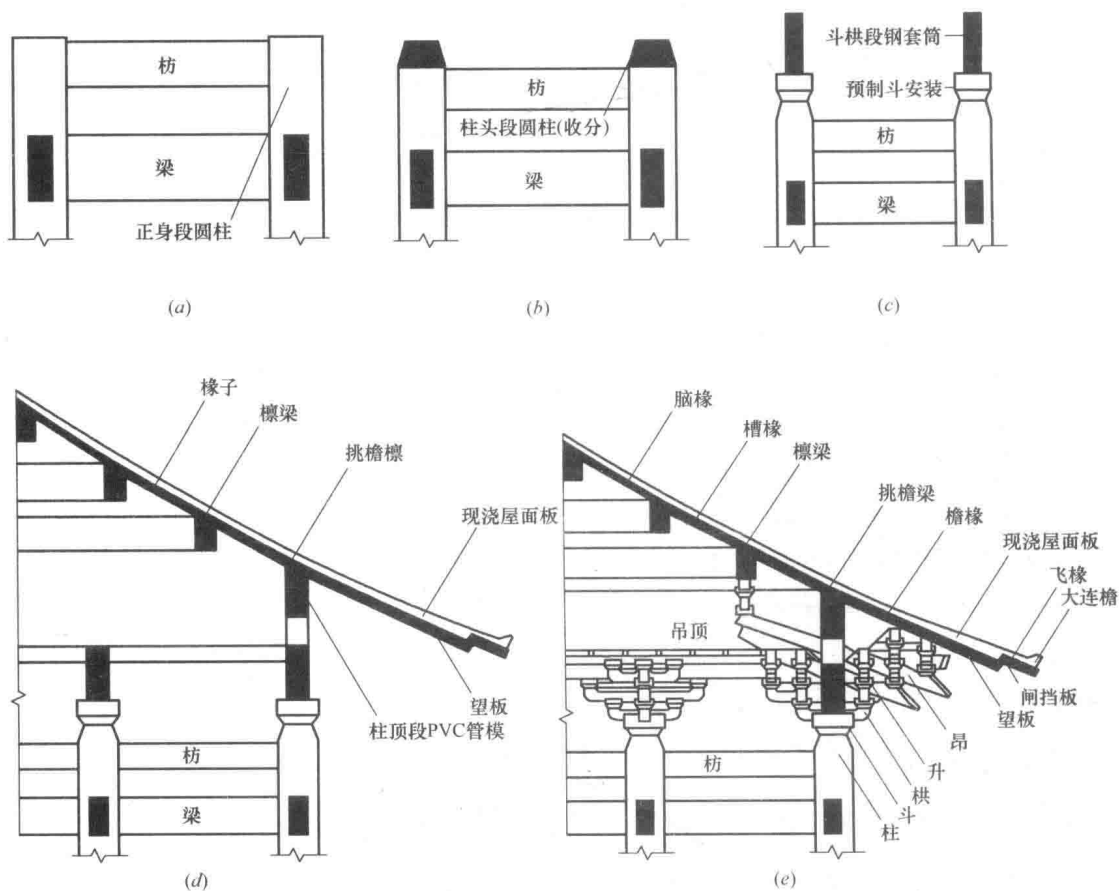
仿古建筑现浇混凝土圆柱施工过程示意图
